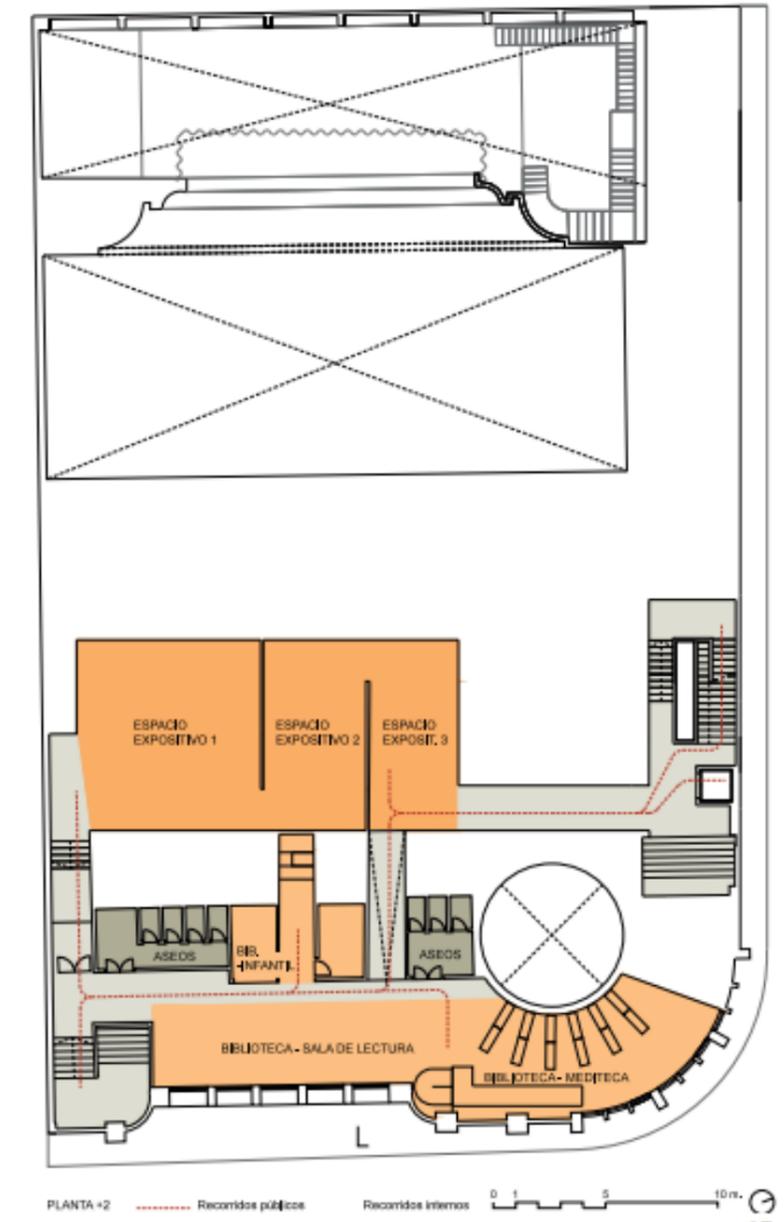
Planta arquitectónica Teatro LUX Tercer Nivel
